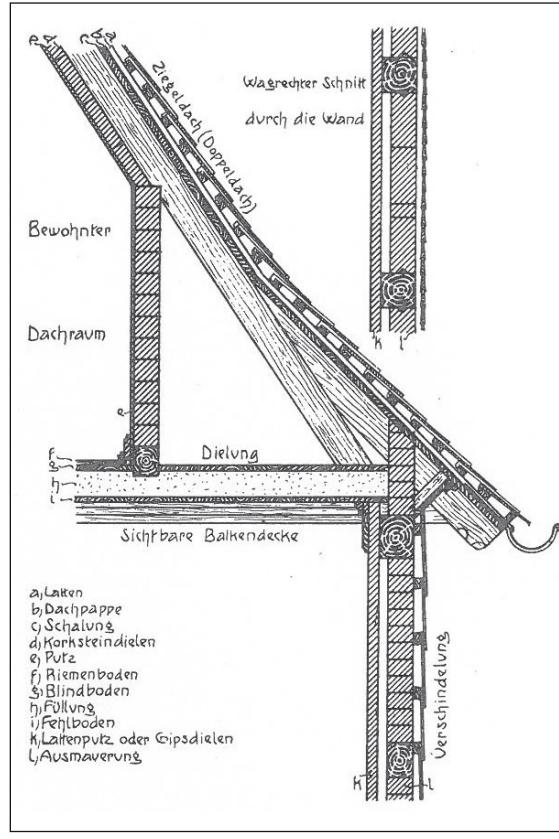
Schnitt durch eine Fachwerkwand und Dachkonstruktion nach [7]. Ausmauerung ($\frac{1}{2}$ -Stein) mit außenseitigem Wettermantel und raumseitiger Luftschicht zwischen Ausmauerung und Innenputz.
